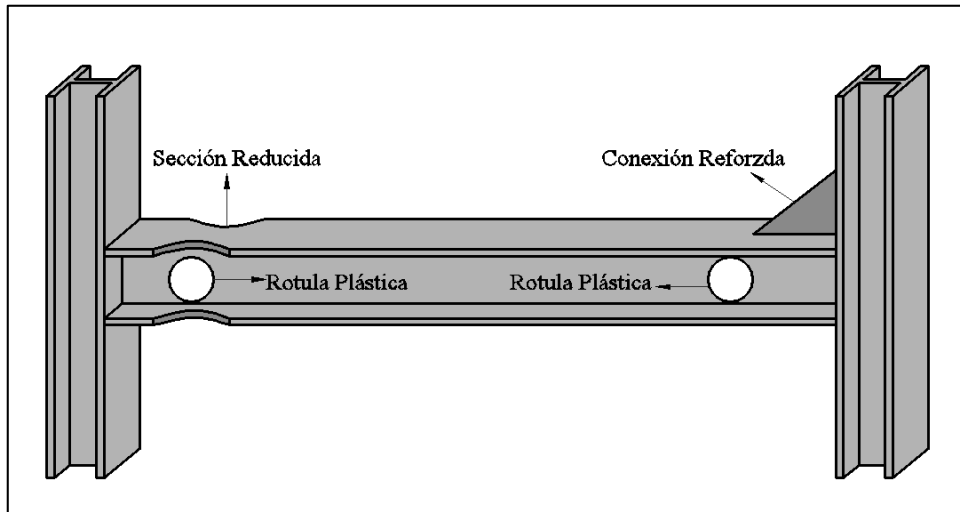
Ubicación de Rotulas Plásticas en Vigas.
